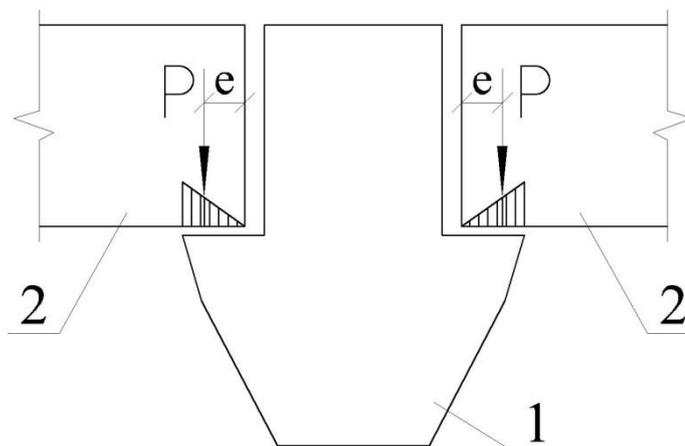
Схема опирания панелей перекрытия на полку ригеля
